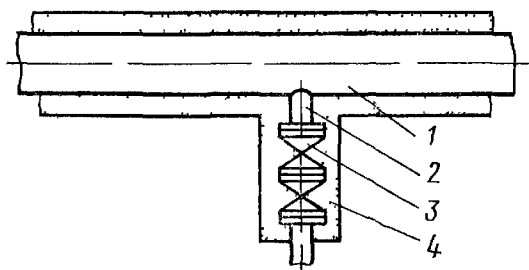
Конструкция спускников (дренажей) на водяных сетях и пусковых дренажей на паропроводах:
